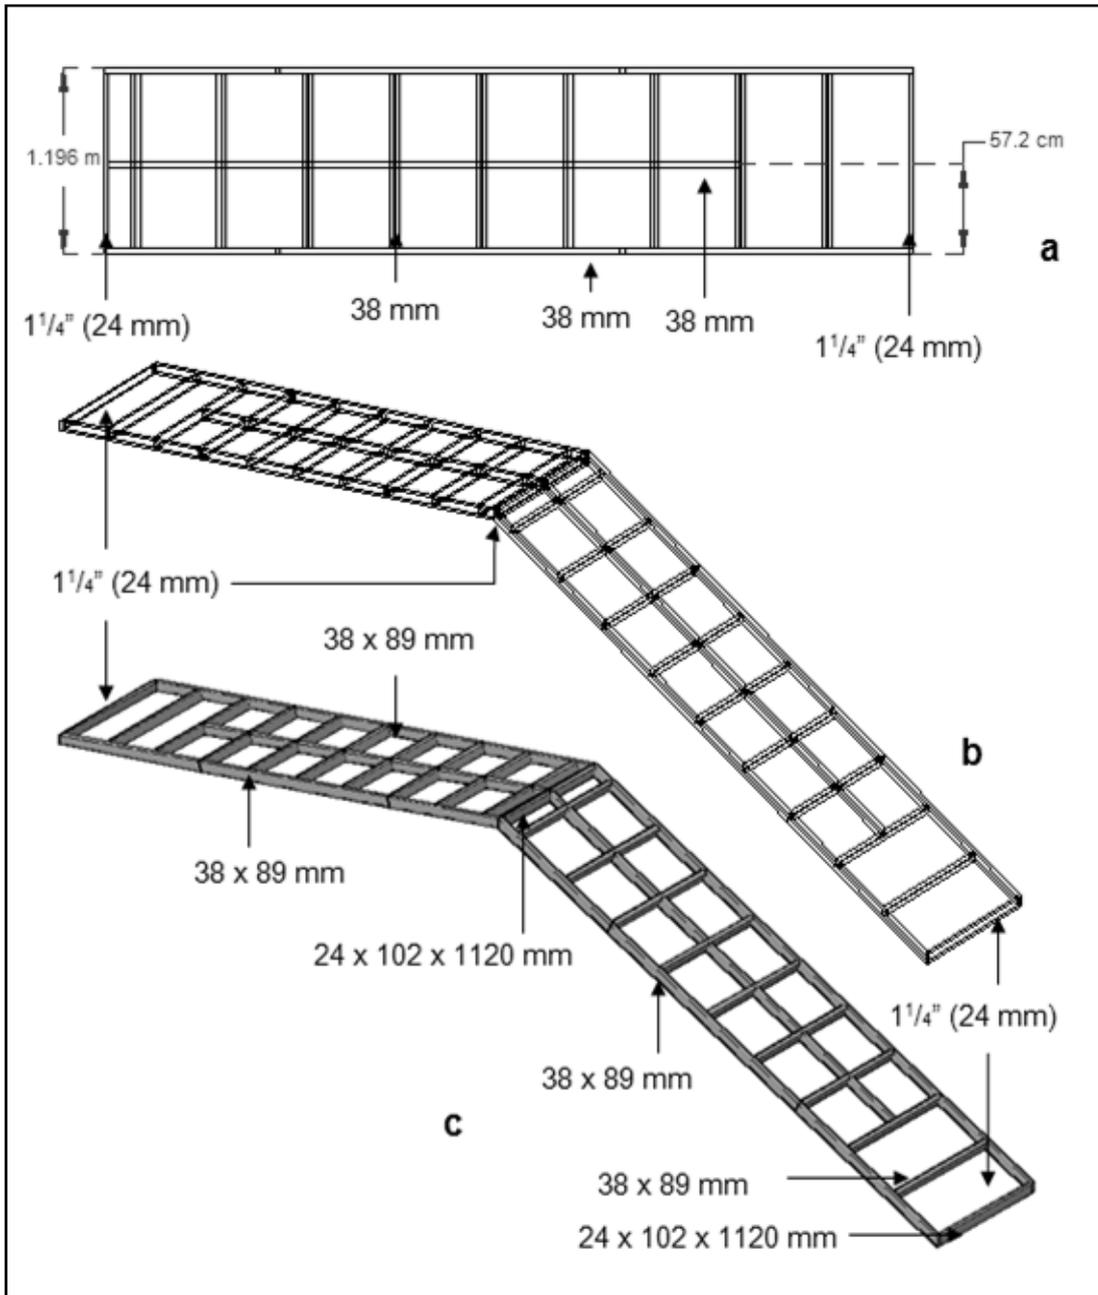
Dimensiones de los aleros: a) Vista superior; b) y c) Vista en isométrico.
